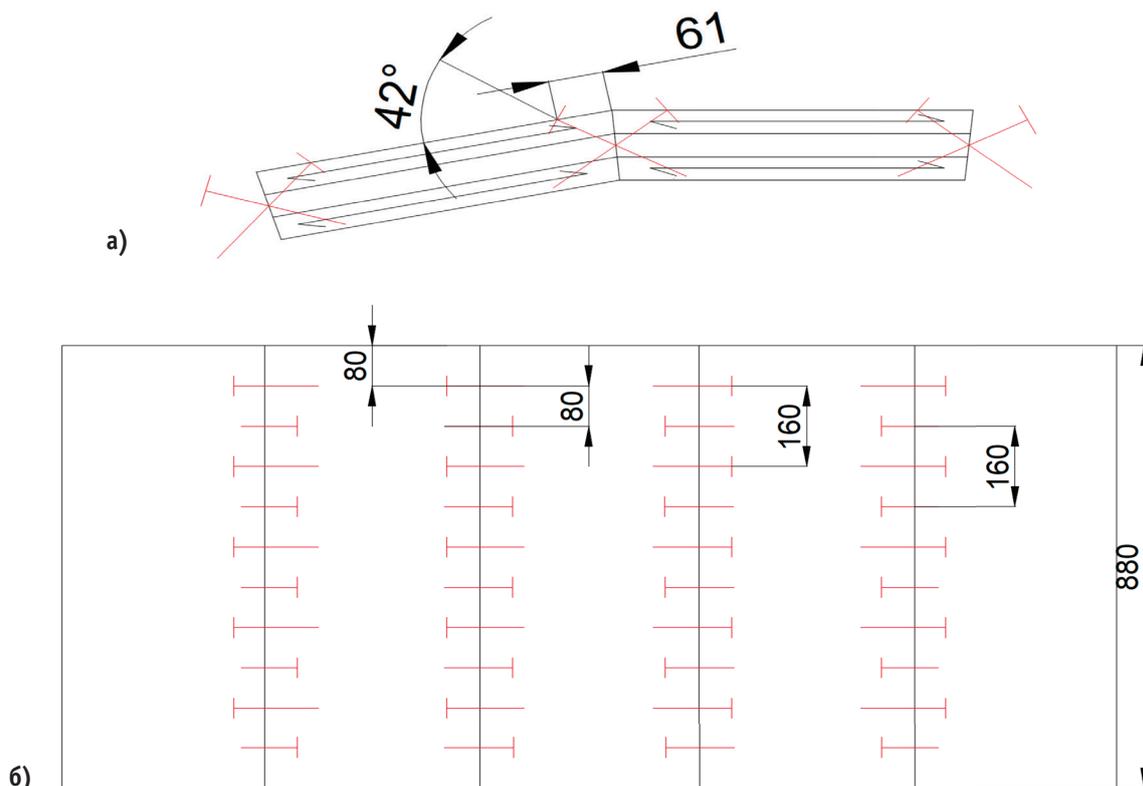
Соединение цилиндрической оболочки из ДПК а) вид сбоку; б) вид сверху
